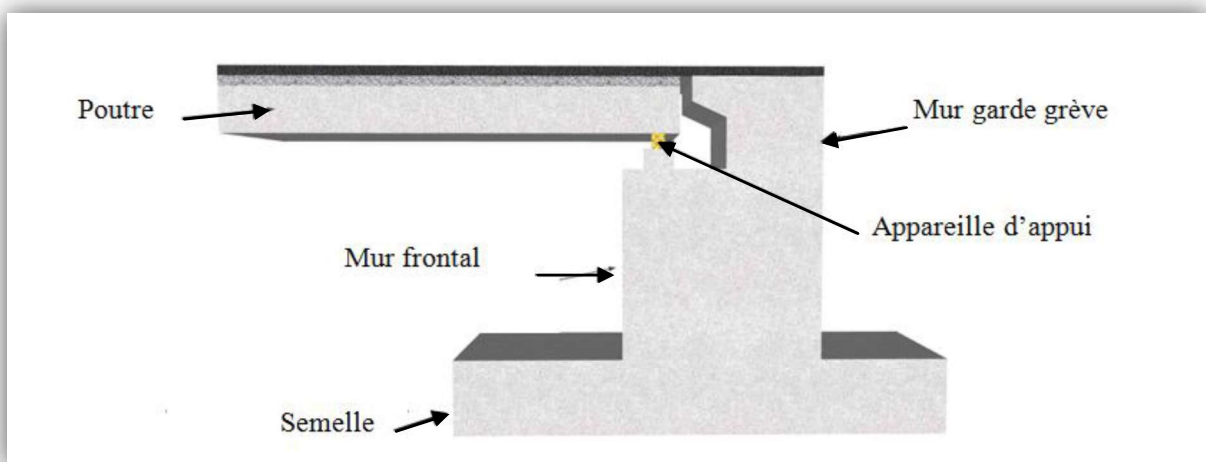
Coupe longitudinale d'une culée d'un pont
